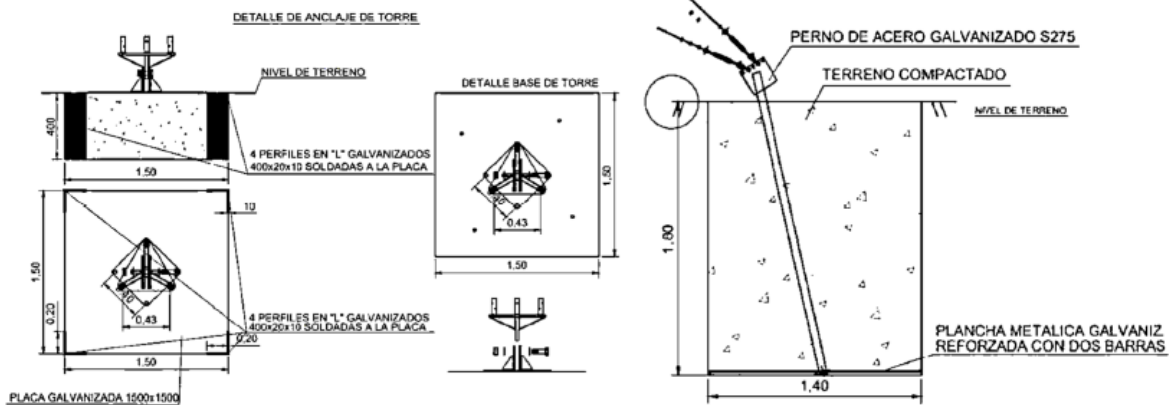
Cimentación, anclaje central y anclaje de cables de la torre arriostrada
